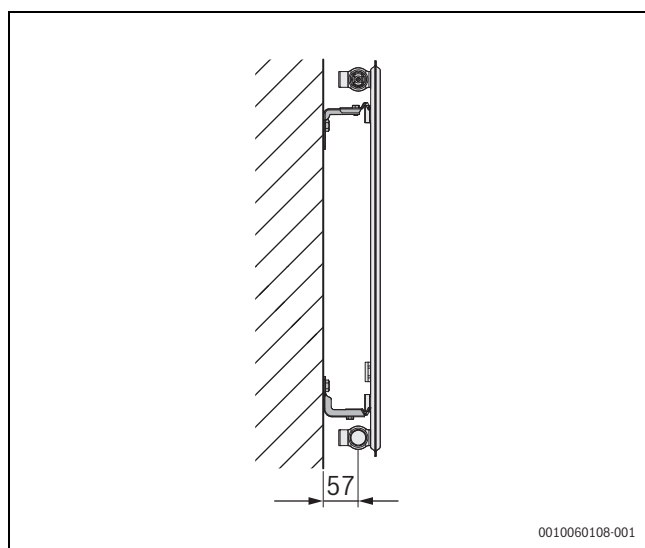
Heizkörperkonsole Typ 10 für VC-, VCM-, C-Plan/Profil.2
